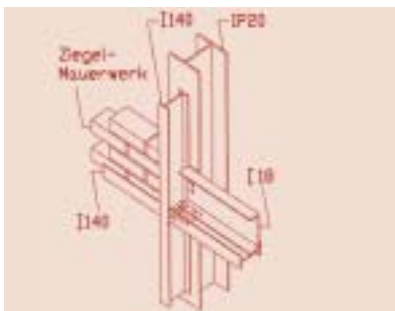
Typisches Fassadendetail beim Zollverein XII
